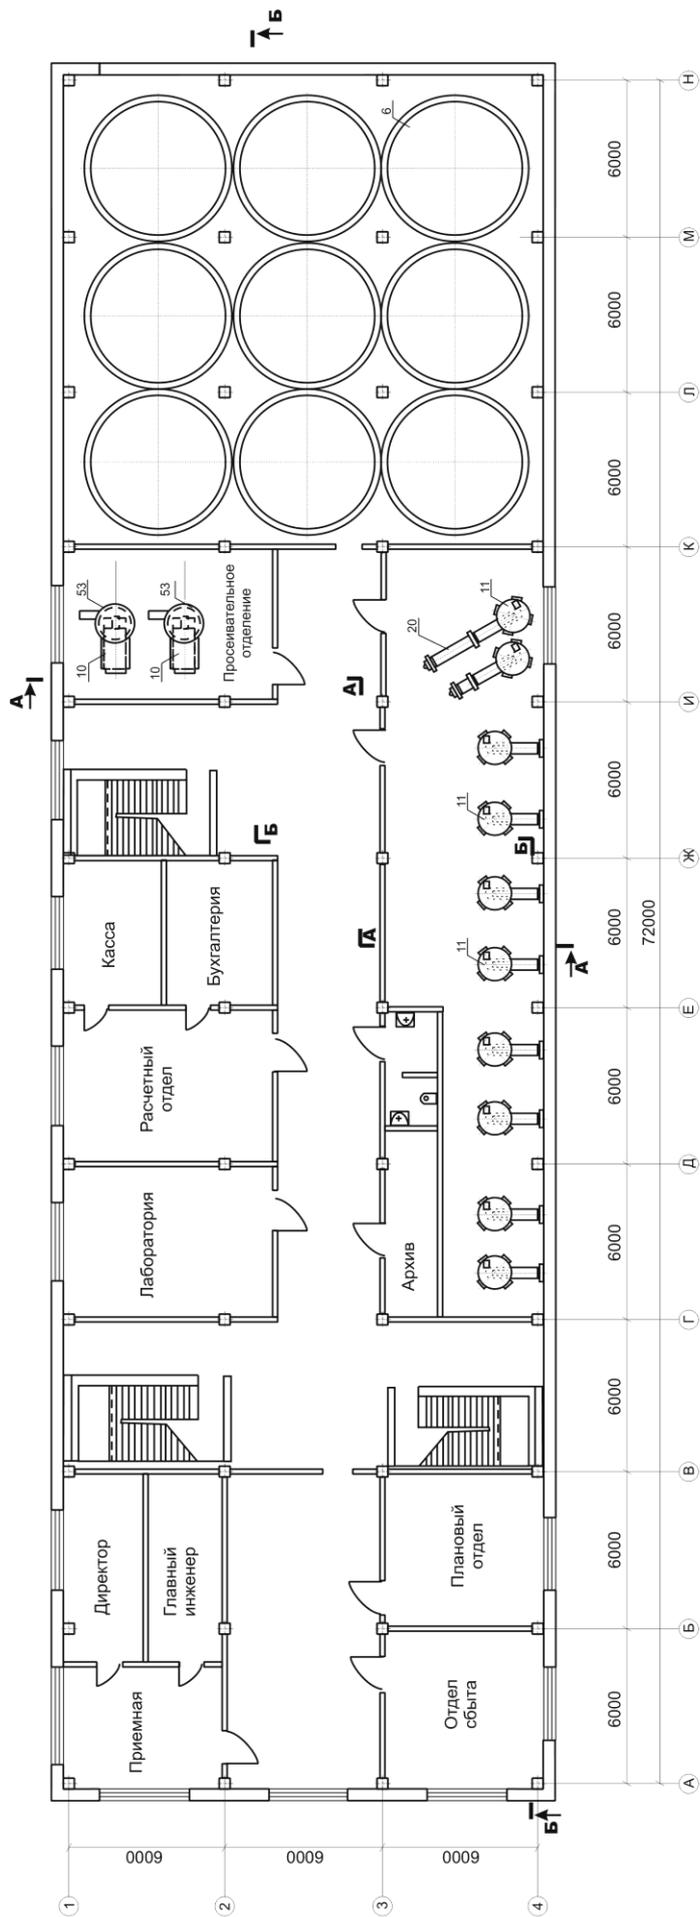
План второго этажа с компоновкой оборудования [2]
